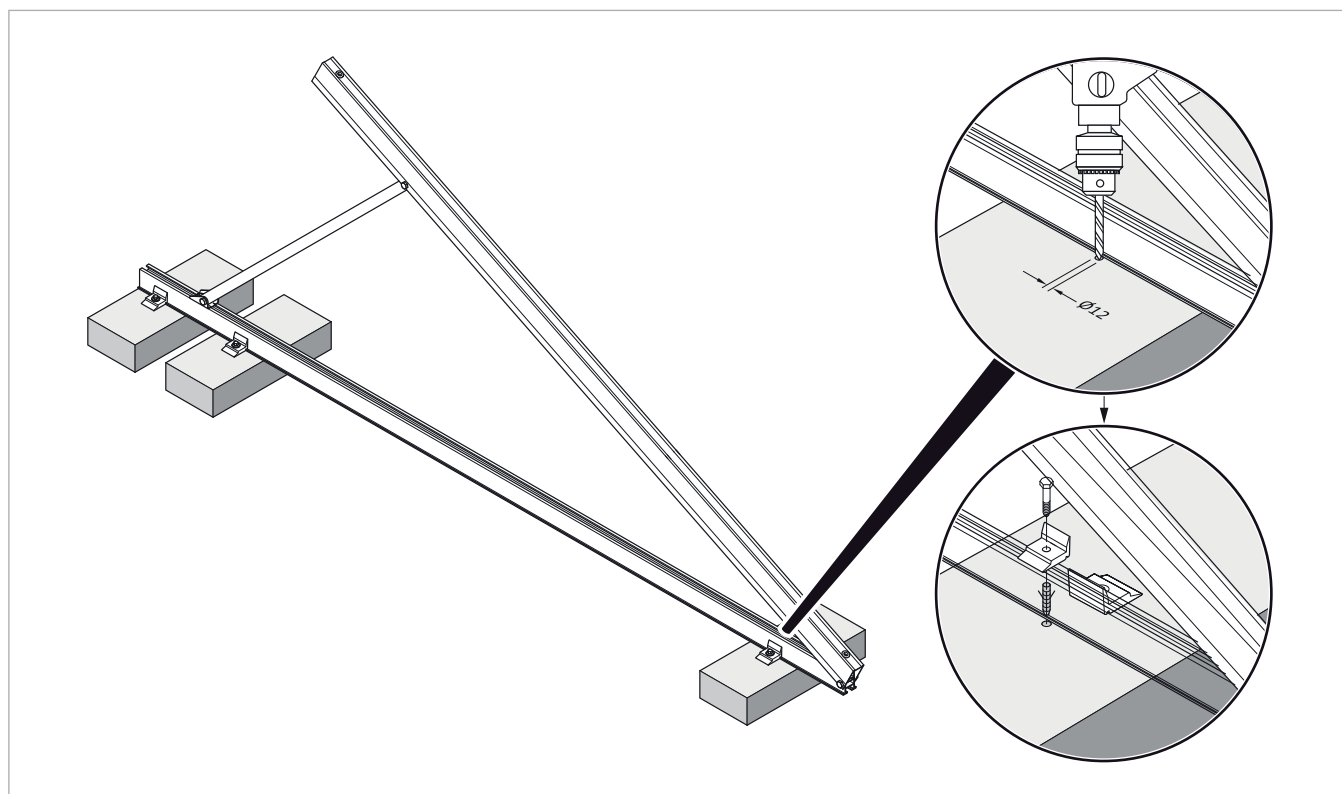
montage du montant pour toit plat sur bloc de béton
